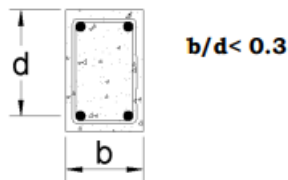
Longitud máxima para elementos sometidos a flexión.
